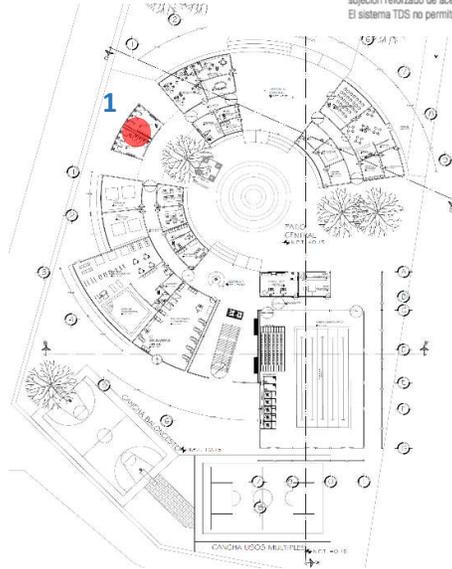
Vista de Planta Baja del Complejo, donde se ubica la posición de los muebles sanitarios (Mingitorios).
